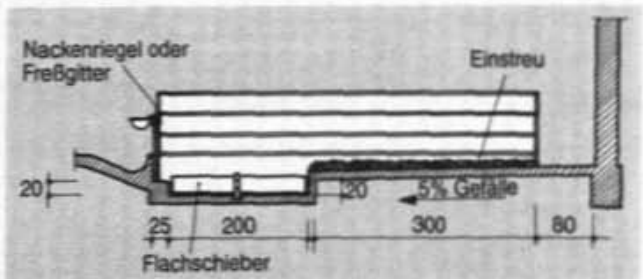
Querschnitt durch einen Flachlaufstall für Mastbullen (Maße in cm).
